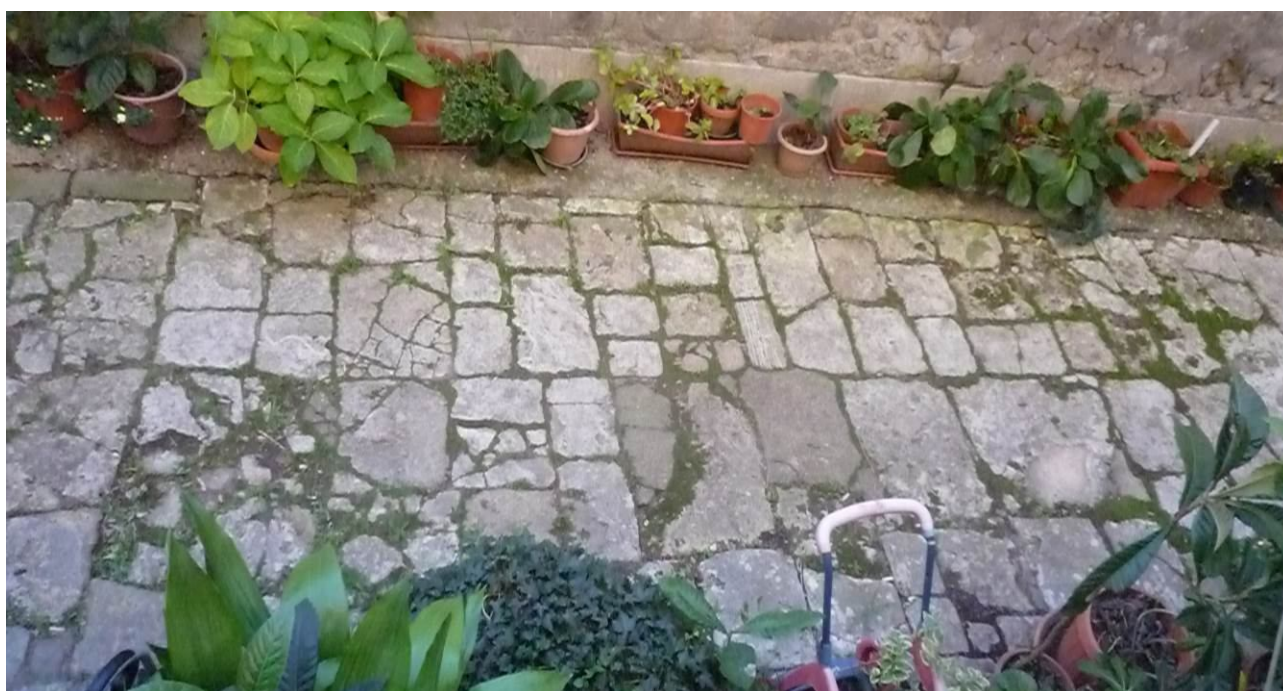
Scansano. Pavimentazione stradale in pietra. (foto dell'autore)
